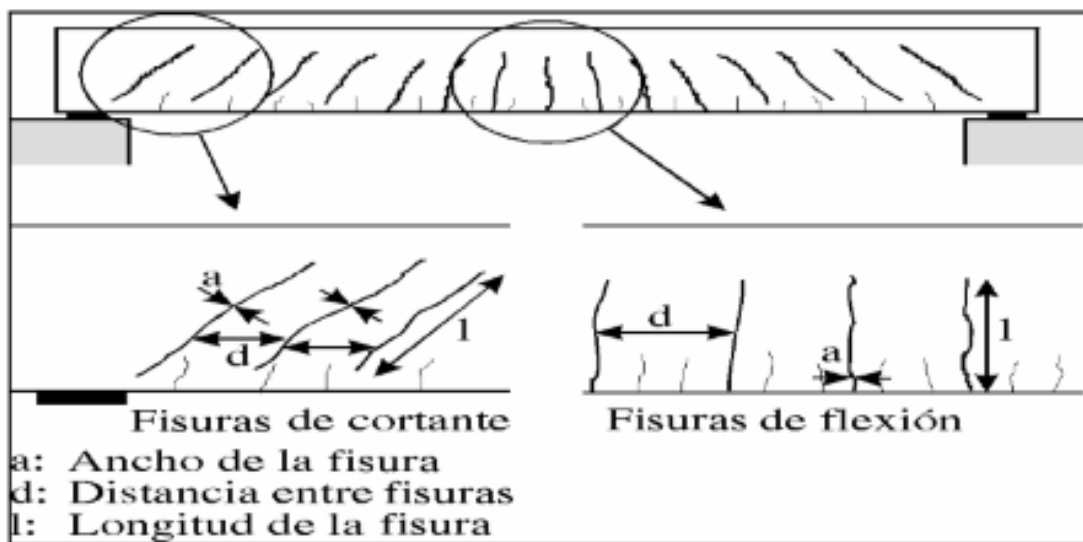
Patrón de fisuramiento en vigas simplemente apoyadas.
